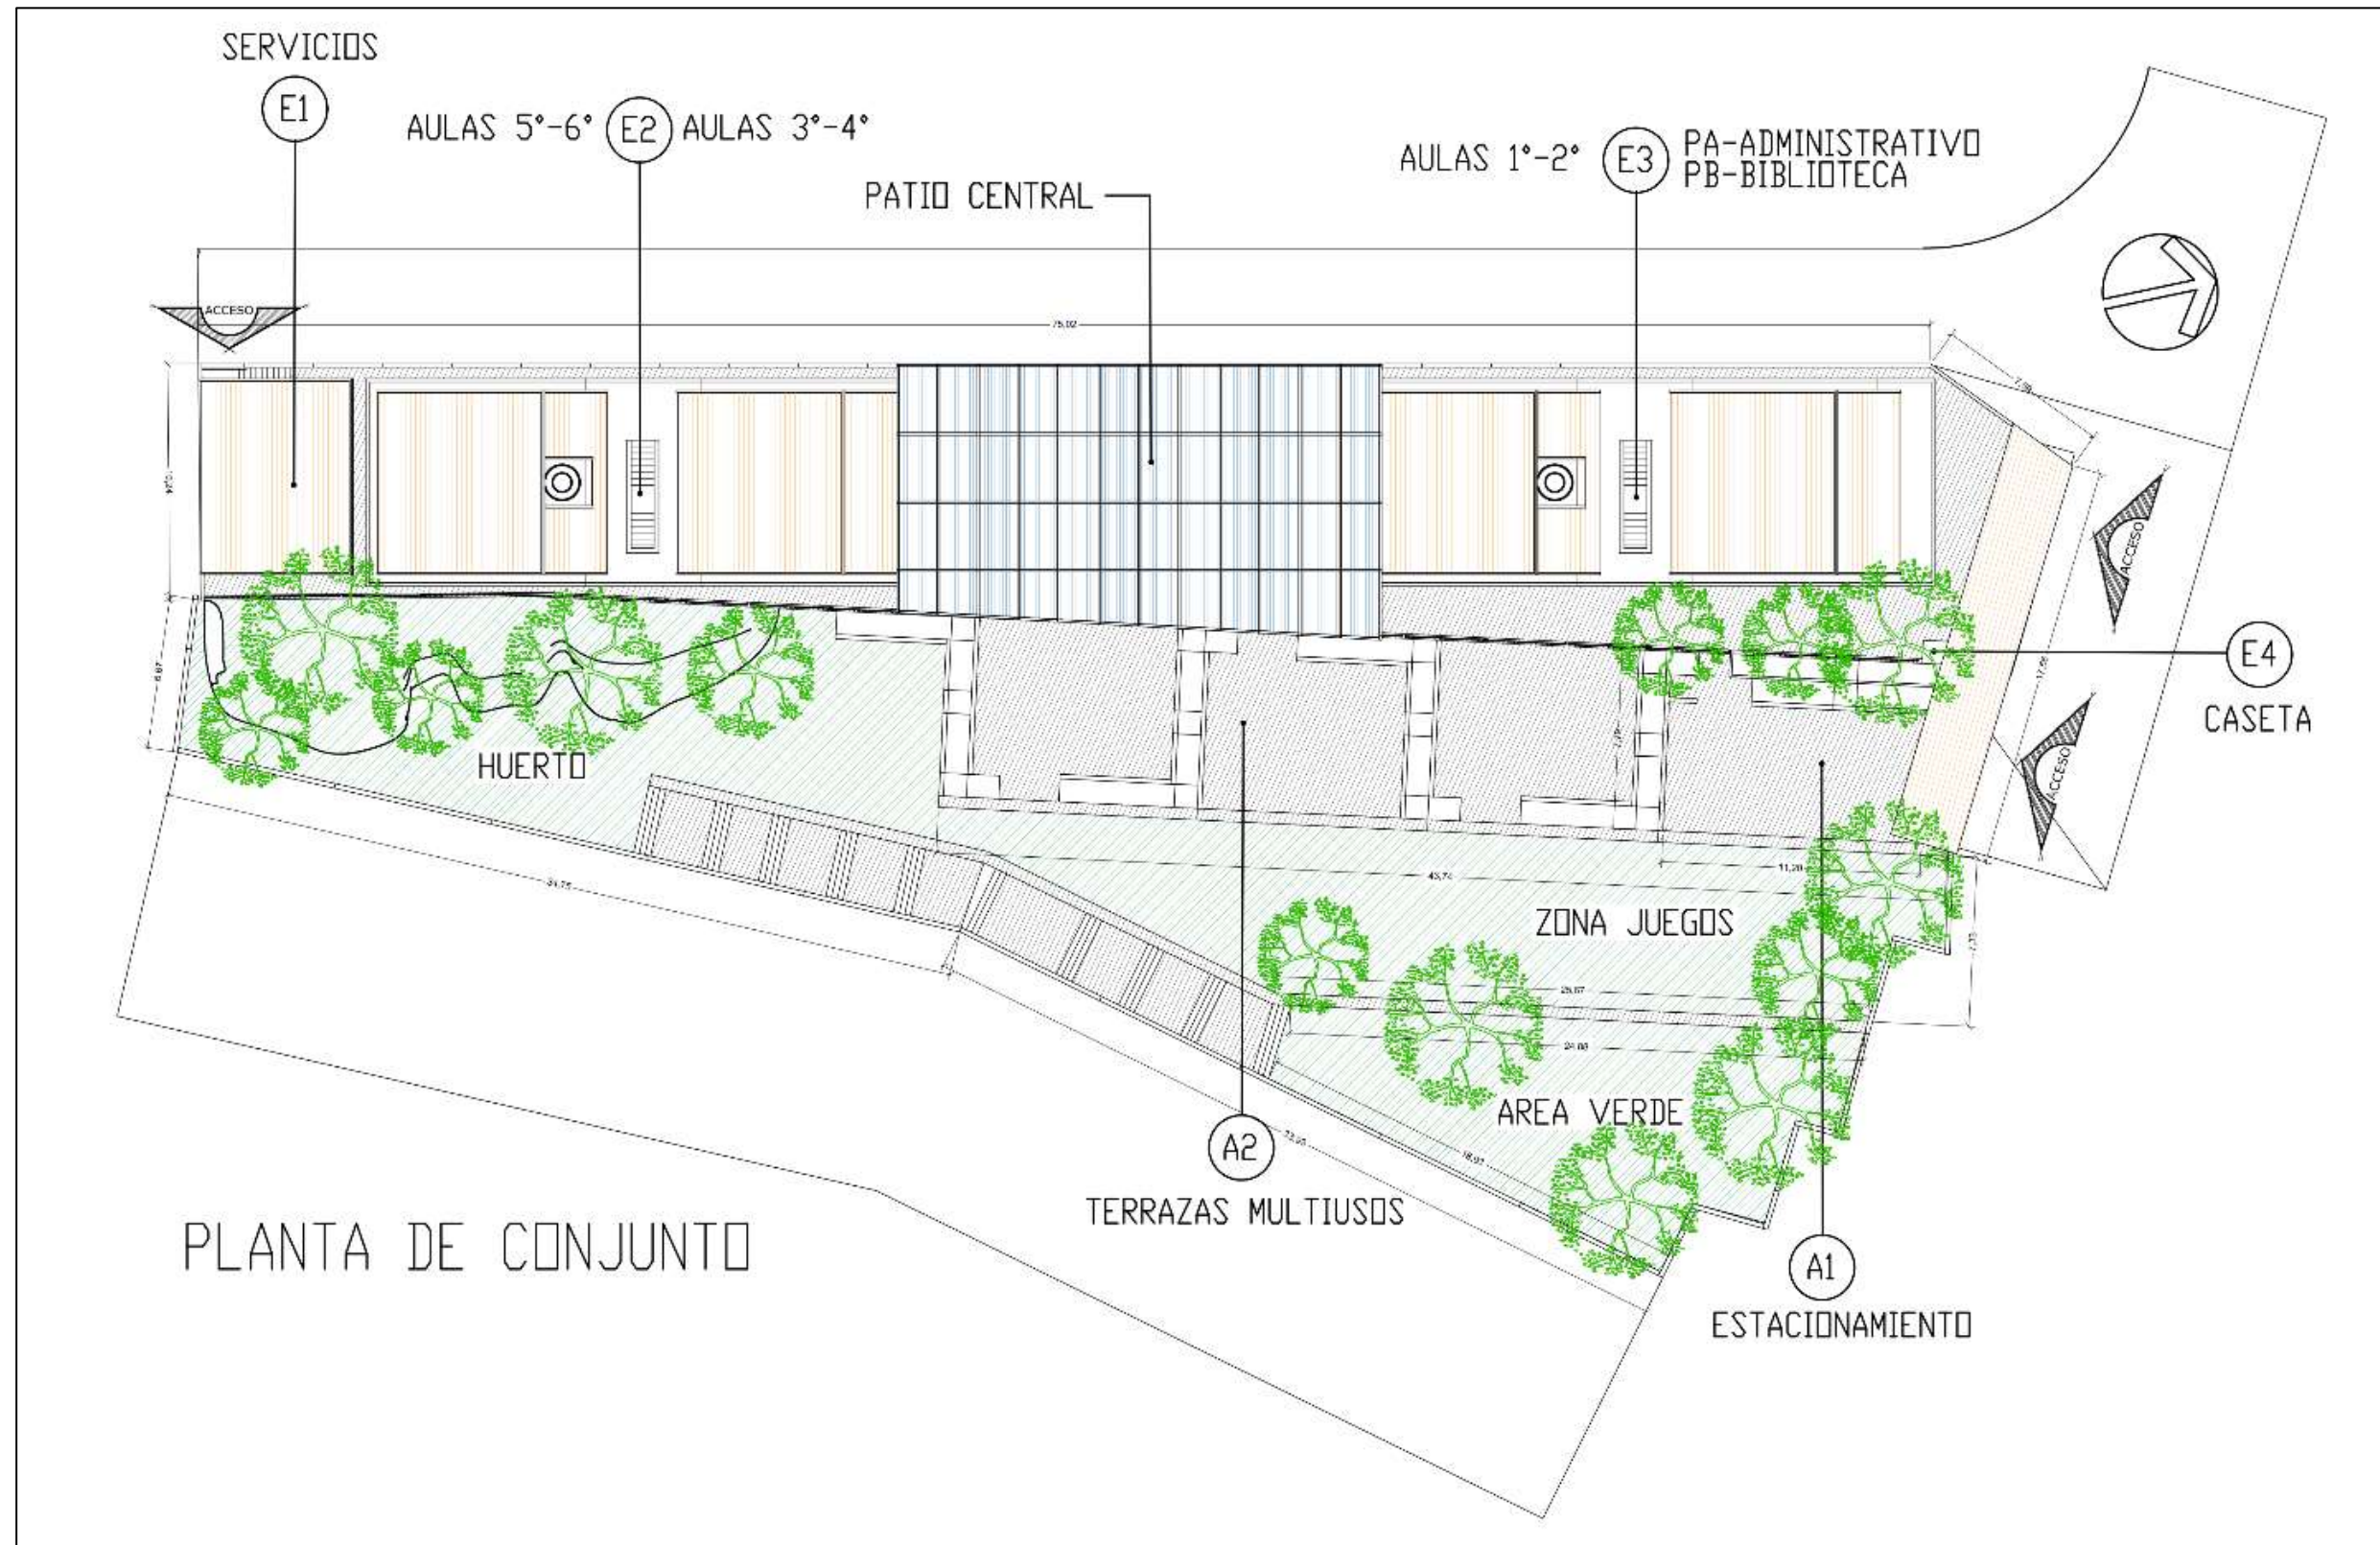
Plano-Planta de conjunto. Fuente: Elaboración propia
